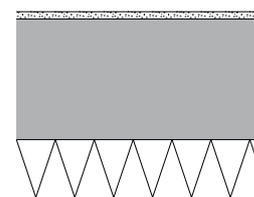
Aufbau Ziegelkonstruktion mit WDVS
